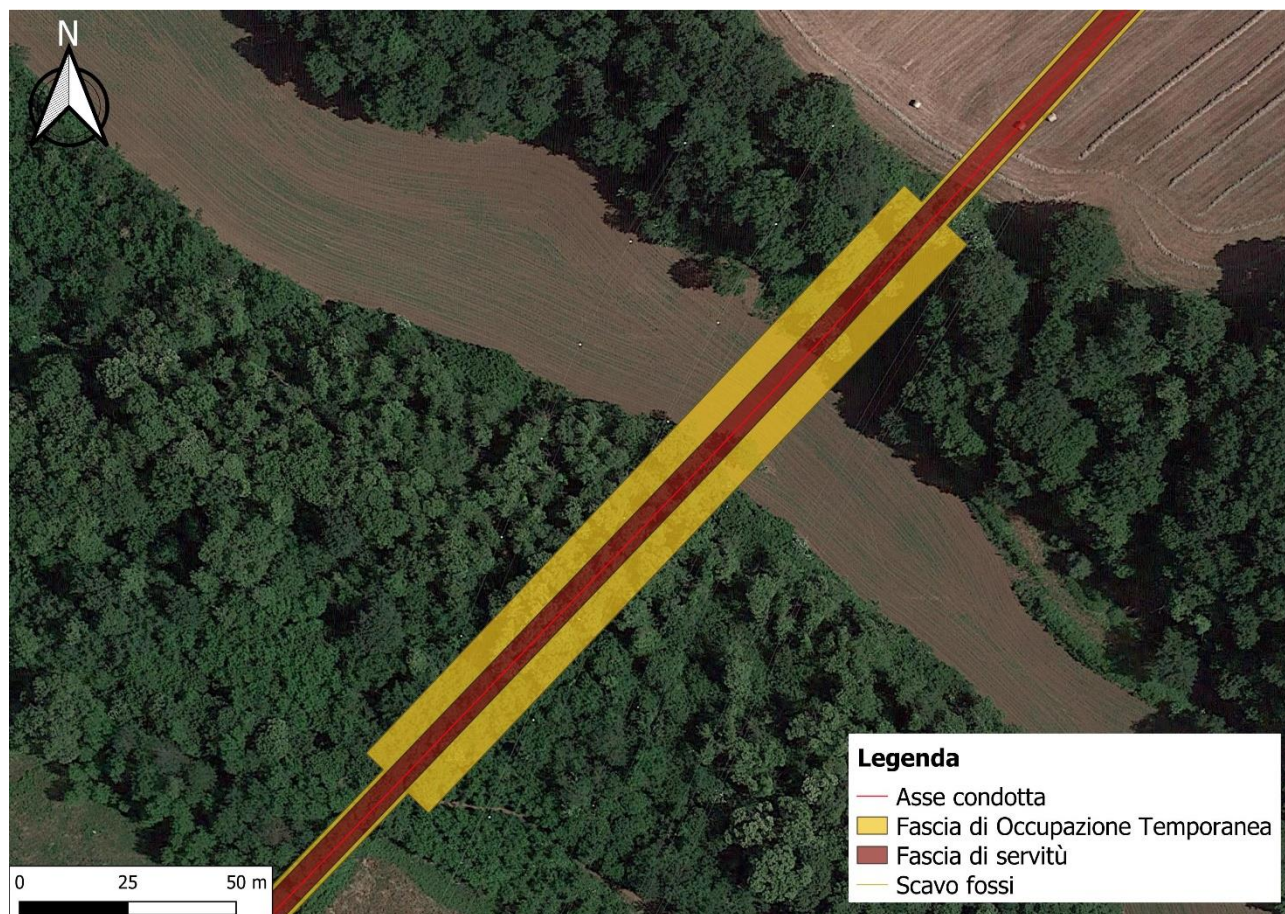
Planimetria attività di lavoro su valle degli Archi
